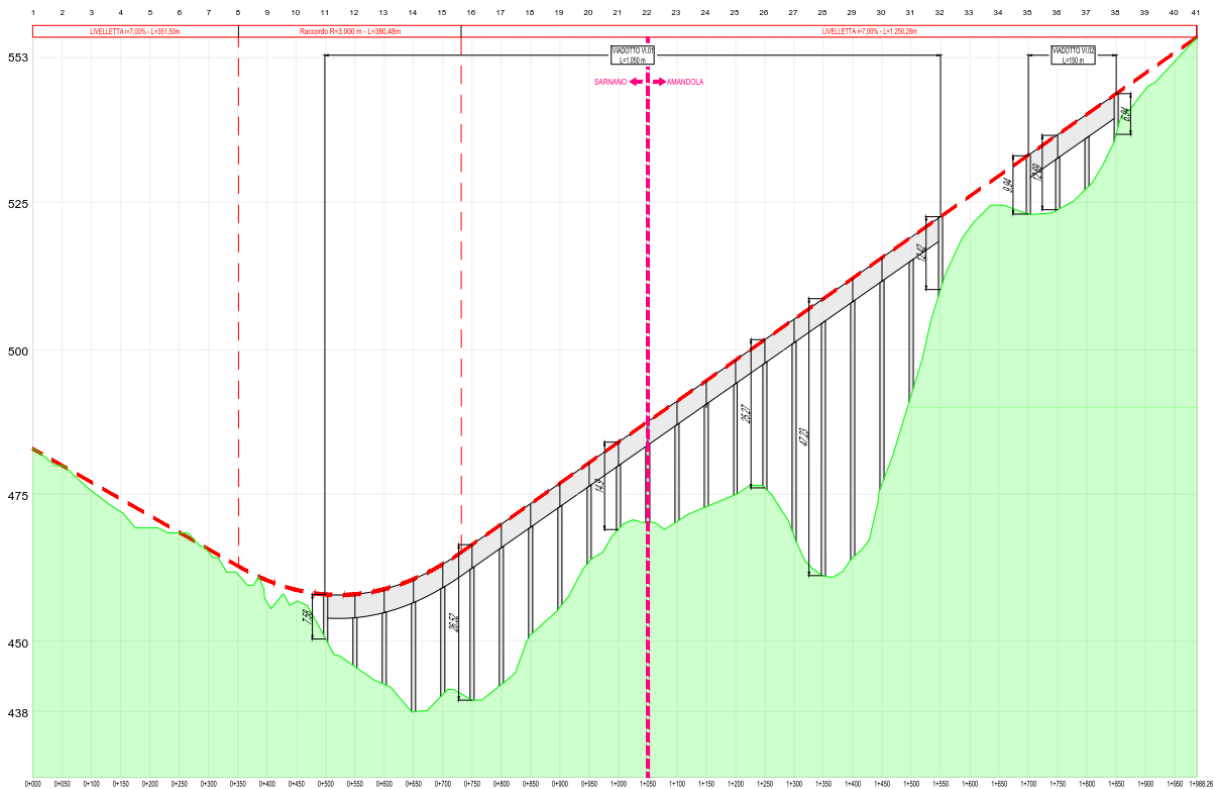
Profilo di progetto – alternativa di tracciato n.1
